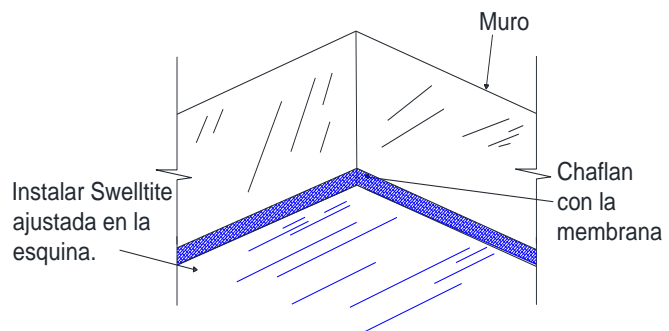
Detalle de un ángulo de transición de impermeabilización.
